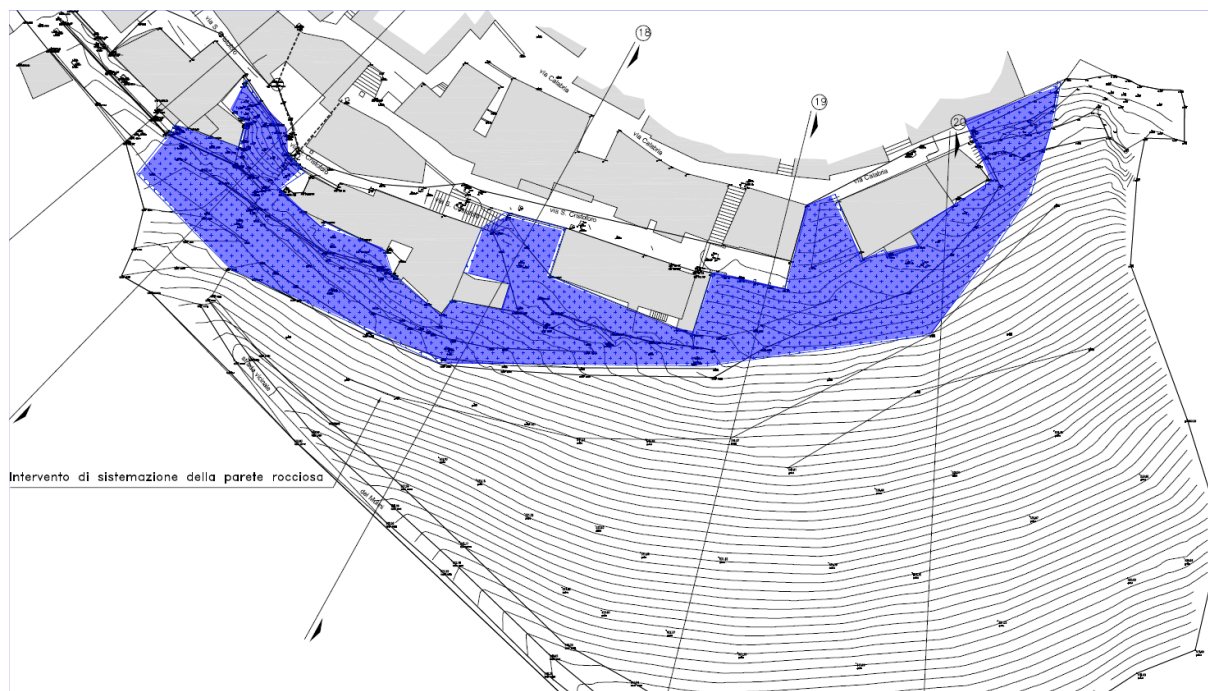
Planimetria di dettaglio – Via S.Cristoforo
